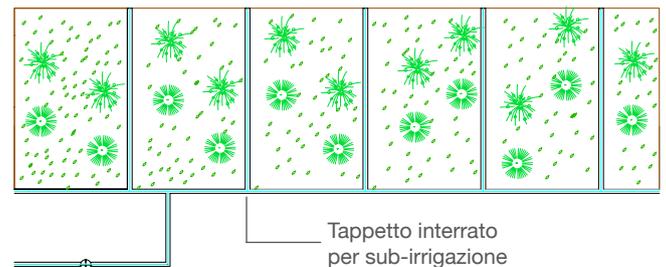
Vista in pianta tappeto interrato per subirrigazione
